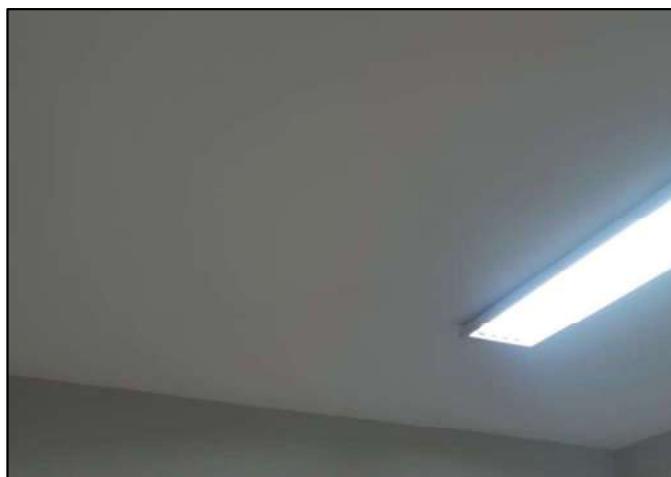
Teto da sala do Gabinete 2 com trinca aparente no reboco da laje
